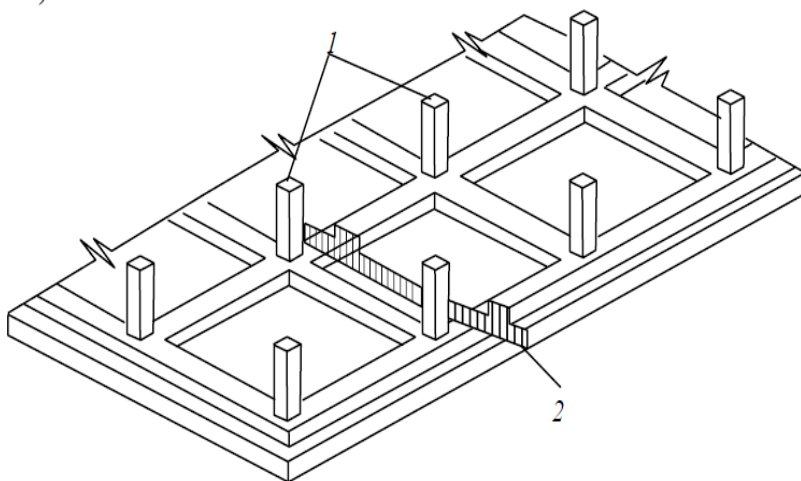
Сплошной фундамент: 1 – колонна; 2 – монолитная плита
